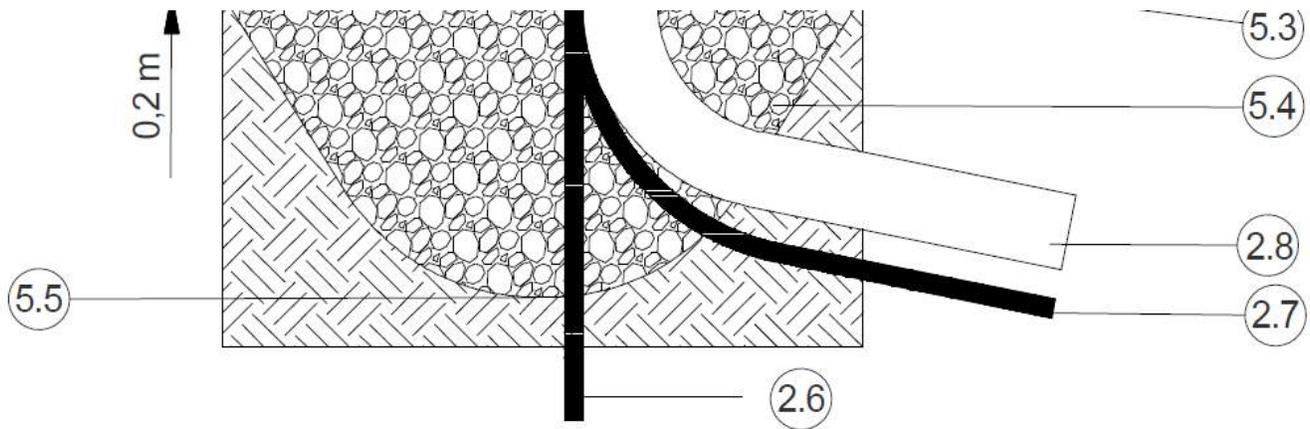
Pianta della fondazione M Flex e System M Comfort con letto di ghiaia
